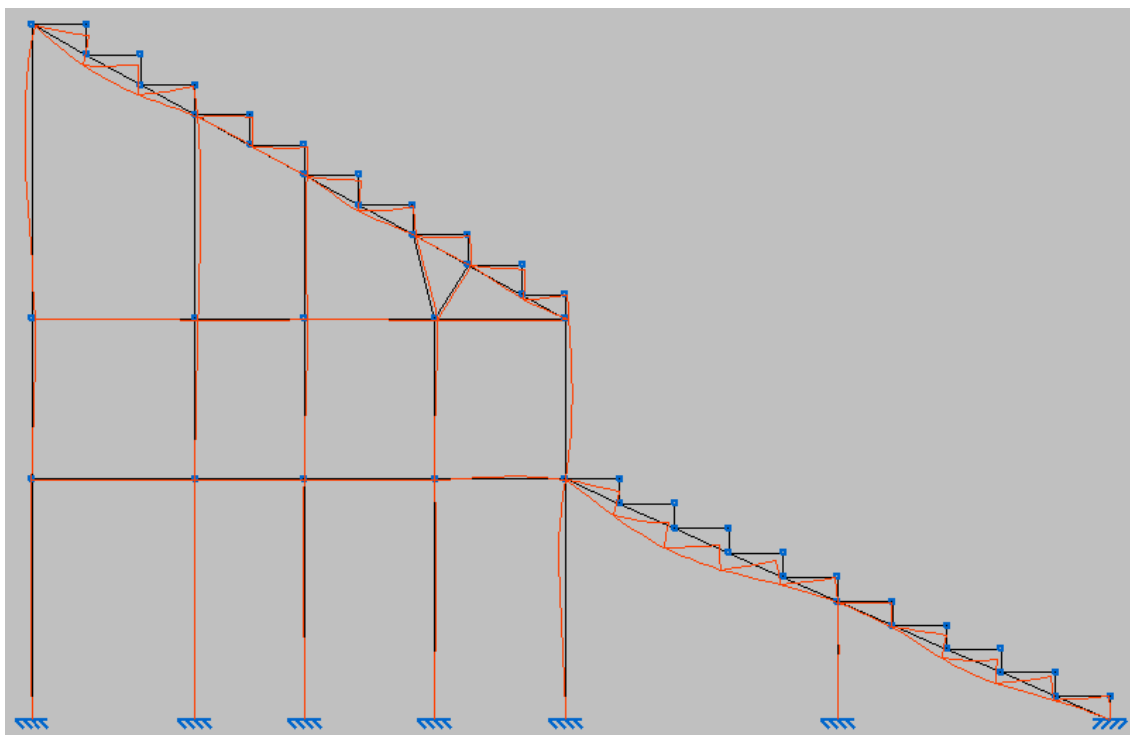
Deformada con vigas inclinadas y nuevos pilares
